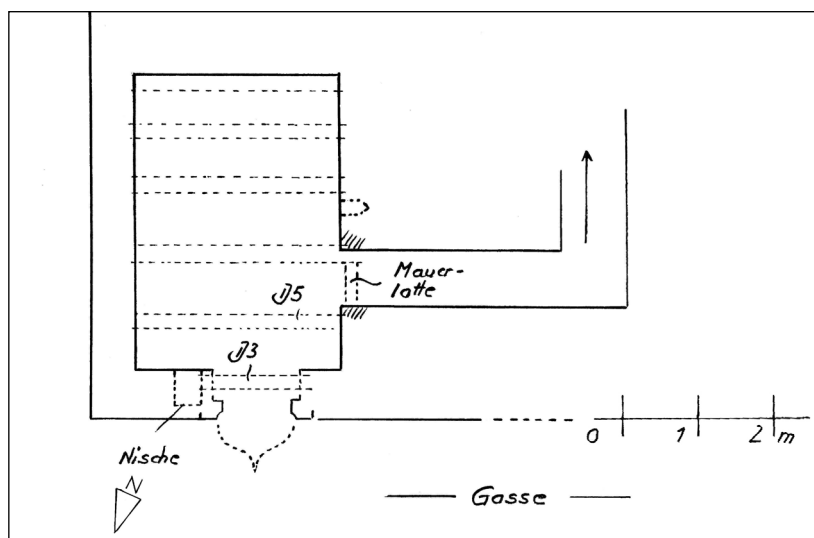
St. Johannesgasse 28, Grundriss Keller.
